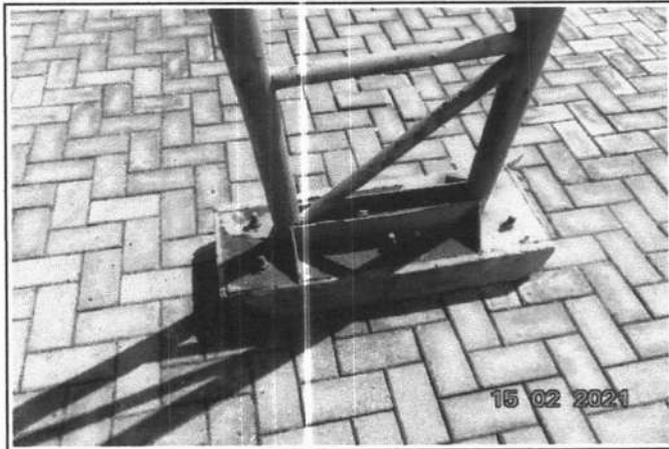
ENVELOPAMENTO DE PILARES METÁLICOS
